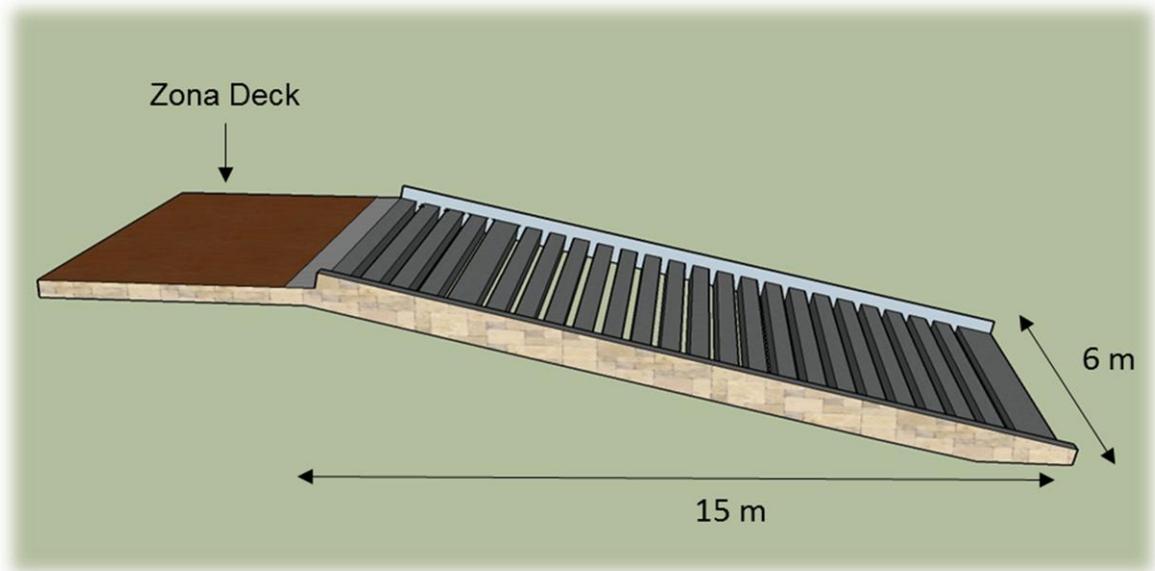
Vista Perfil de rampa de concreto del Proyecto Marina Flamingo
